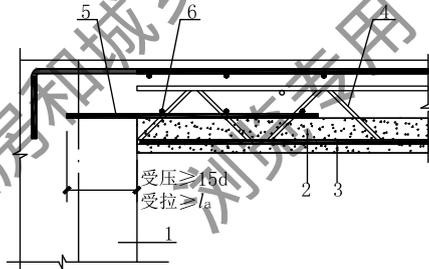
桁架钢筋混凝土叠合板板端构造示意
